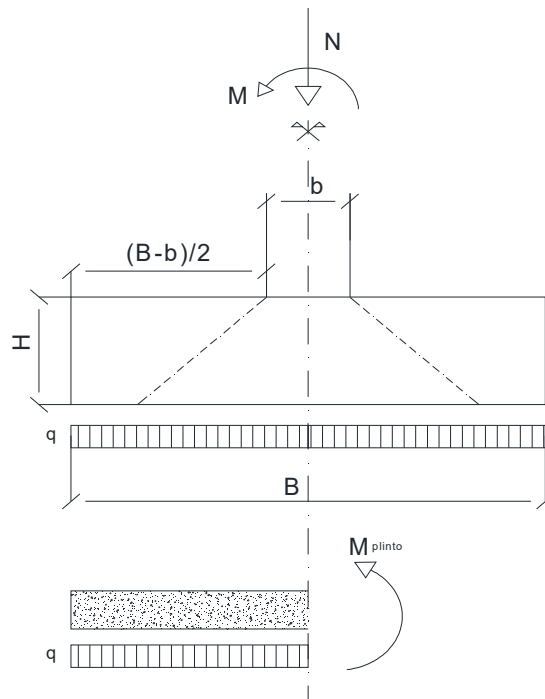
Schema per la modellazione di un plinto di fondazione
